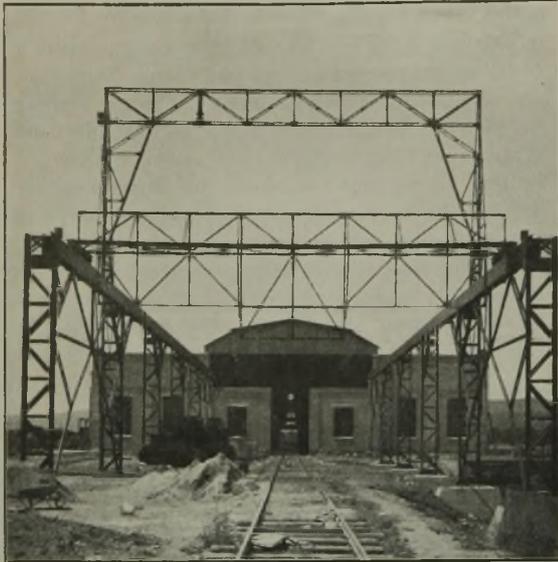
Außenkranbahn mit Fallwerksgerüst und Giebelverschluß.
